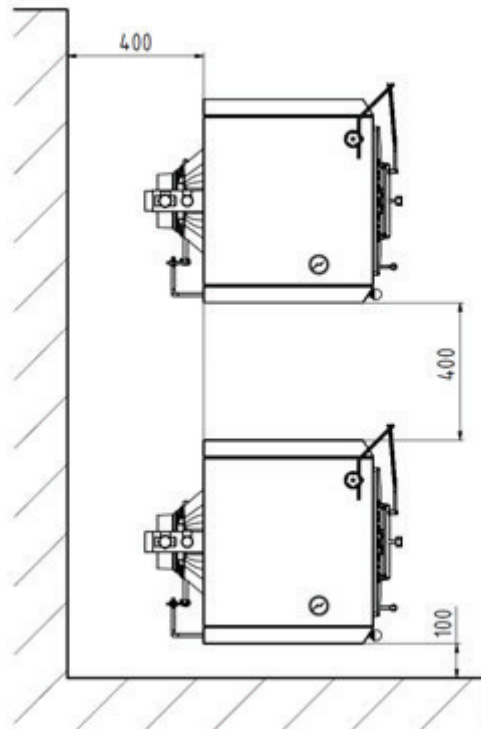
Disposition des chaudières dans la chambre de chauffe
